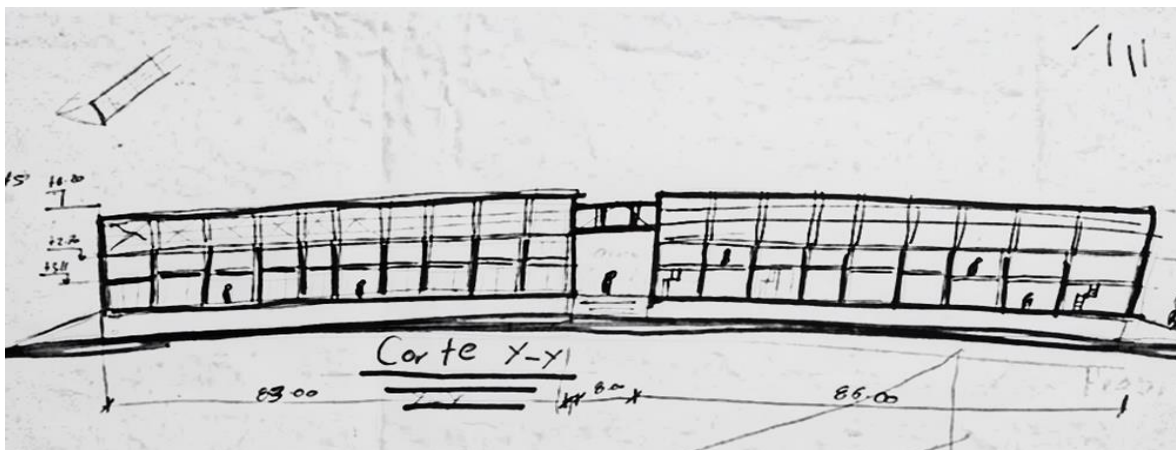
Foto corte Y-Y de la planta de conjunto, Fuente: elaboración propia.
